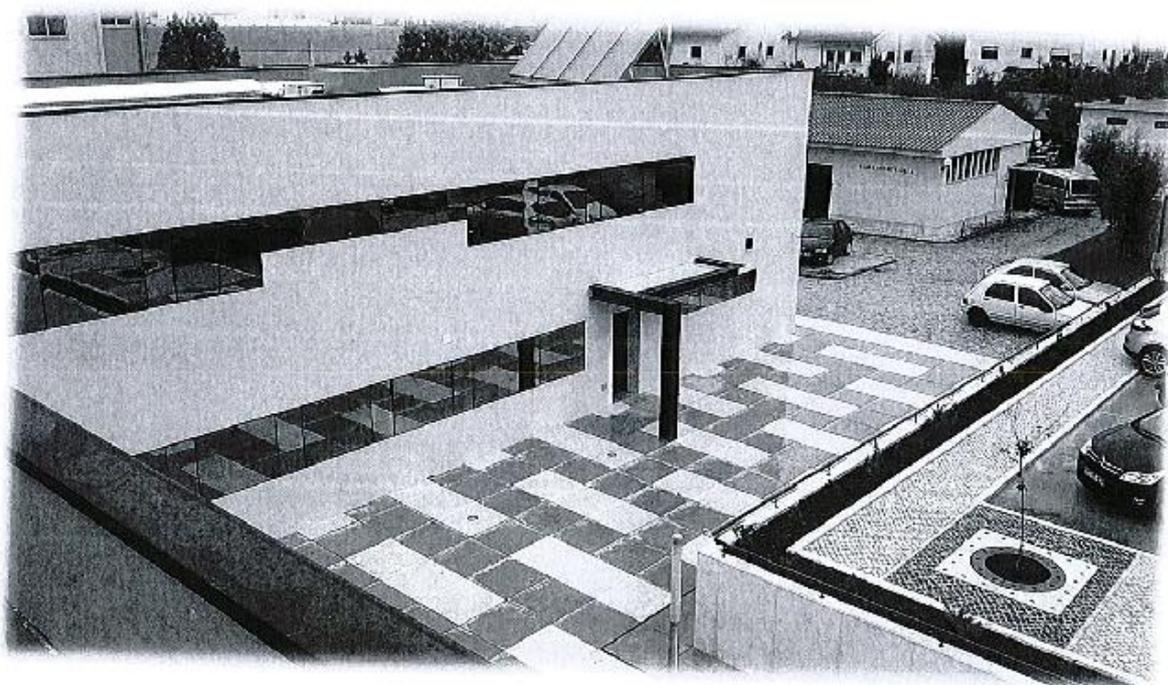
Vista geral sobre arranjos exteriores, muros e floreiras em betão branco e lajeado de betão aplicado em pavimento
